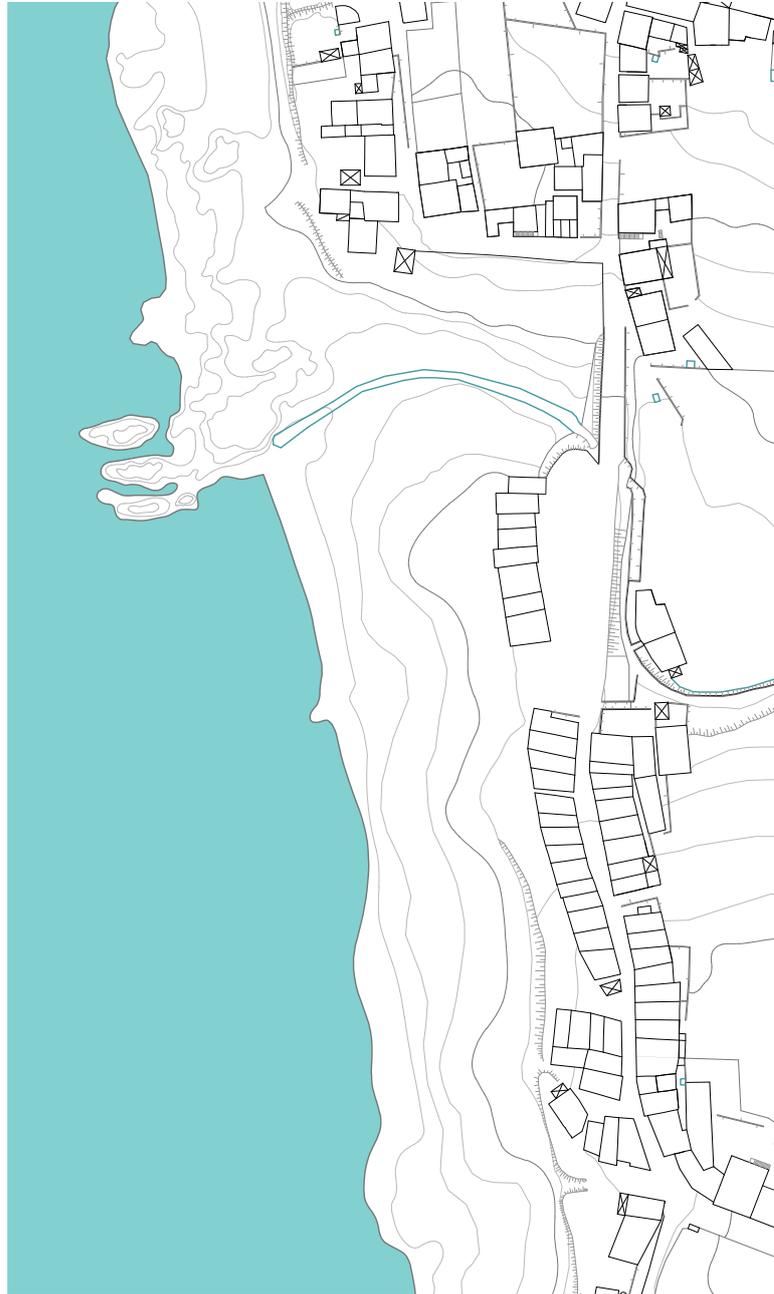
Planta do Largo dos Pescadores do ano 1966.
